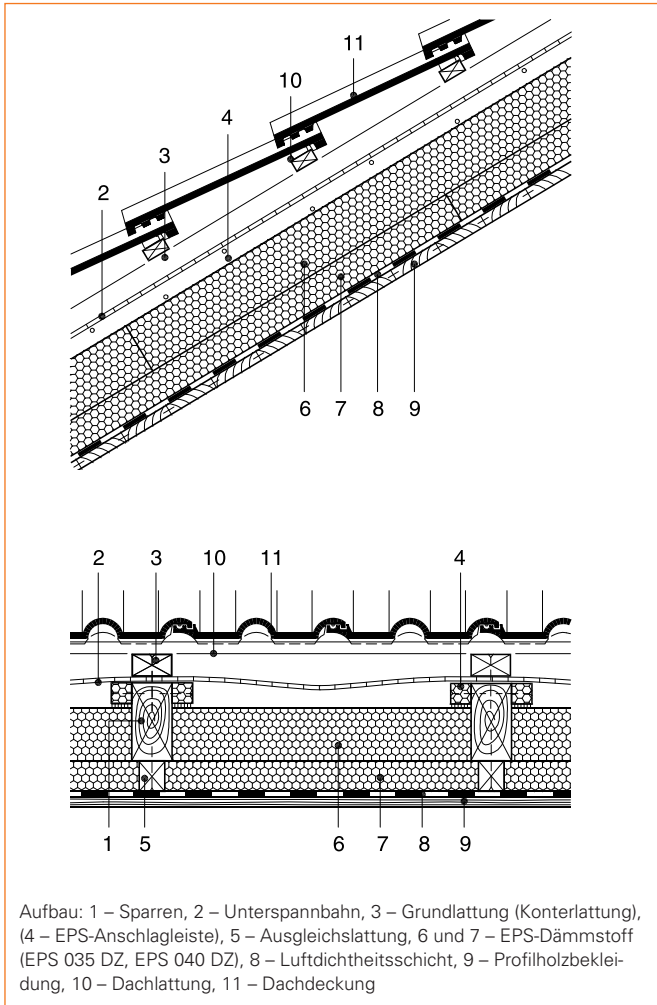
Sanierungsvariante: Steildach-Zwischensparren- und Untersparrendämmung
